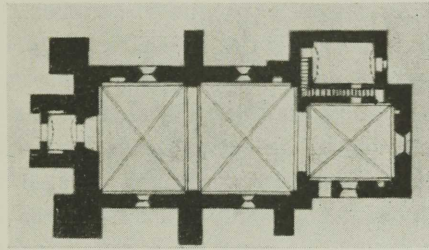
Grundriss der Kirche zu Püha. Nach Guleke.
